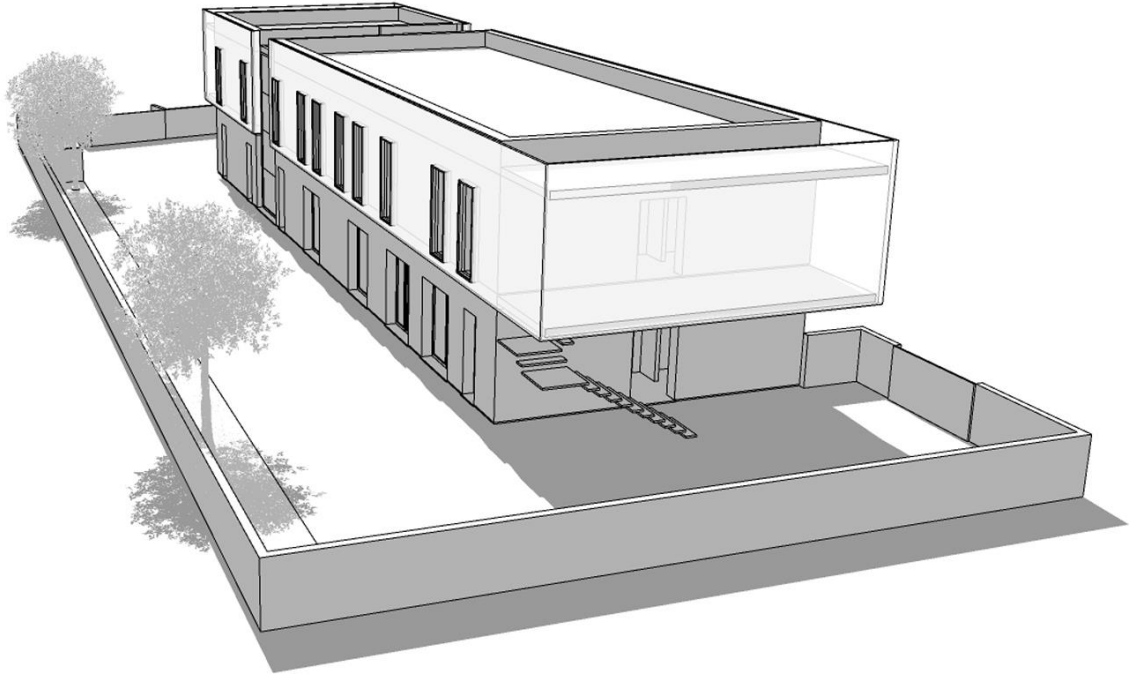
schizzo di progetto preliminare Nuova Sede Croce Rossa di Pontasserchio vista nord-est
